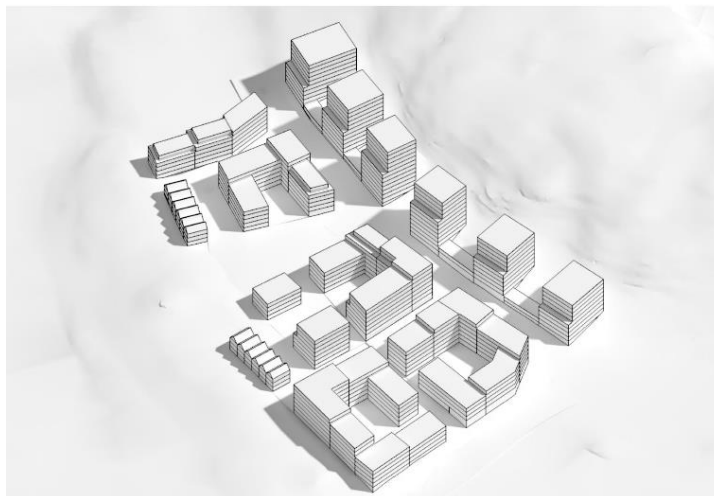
Skiss över planförslaget med den planerade bebyggelsen. Källa C.F. Møller.
